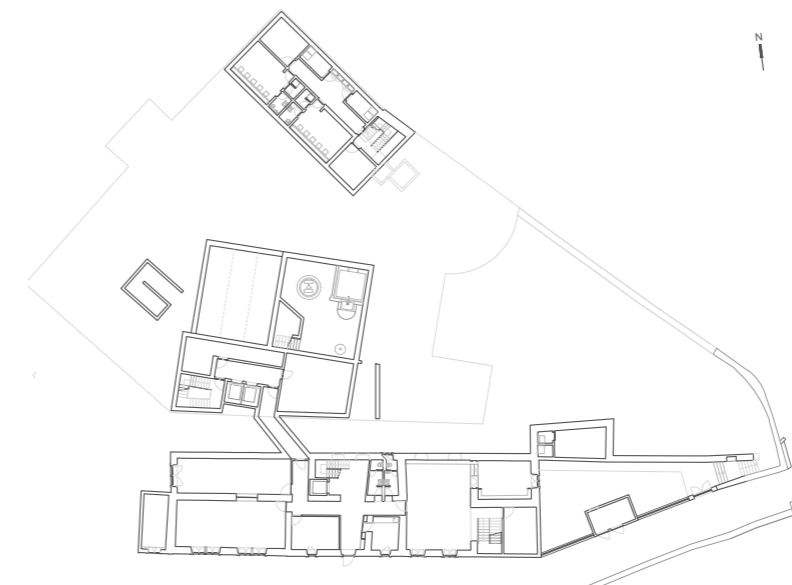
Planta de piso 2 (setas de relações com o espaço central).
